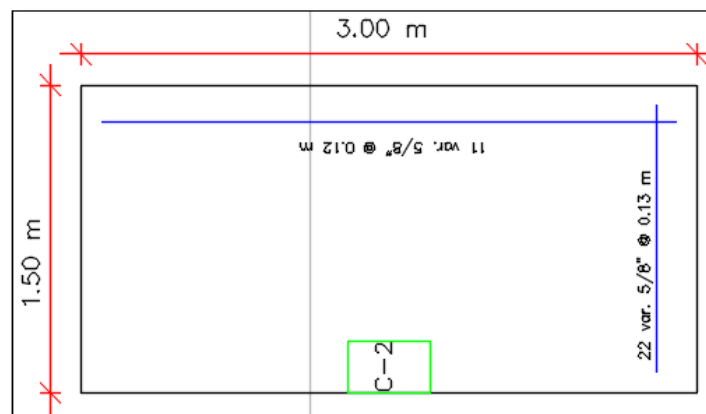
Vista en planta de zapata aislada para columnas excéntricas.
